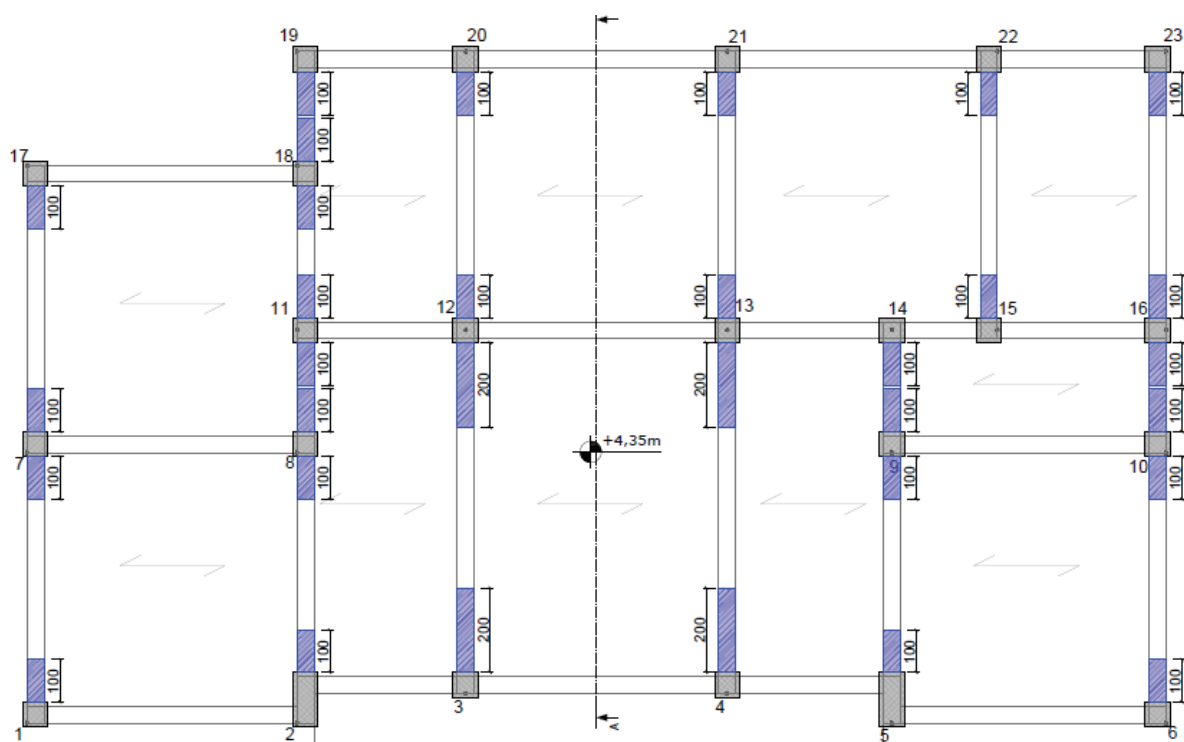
Ringrosso travi – Estratto pianta e particolare
